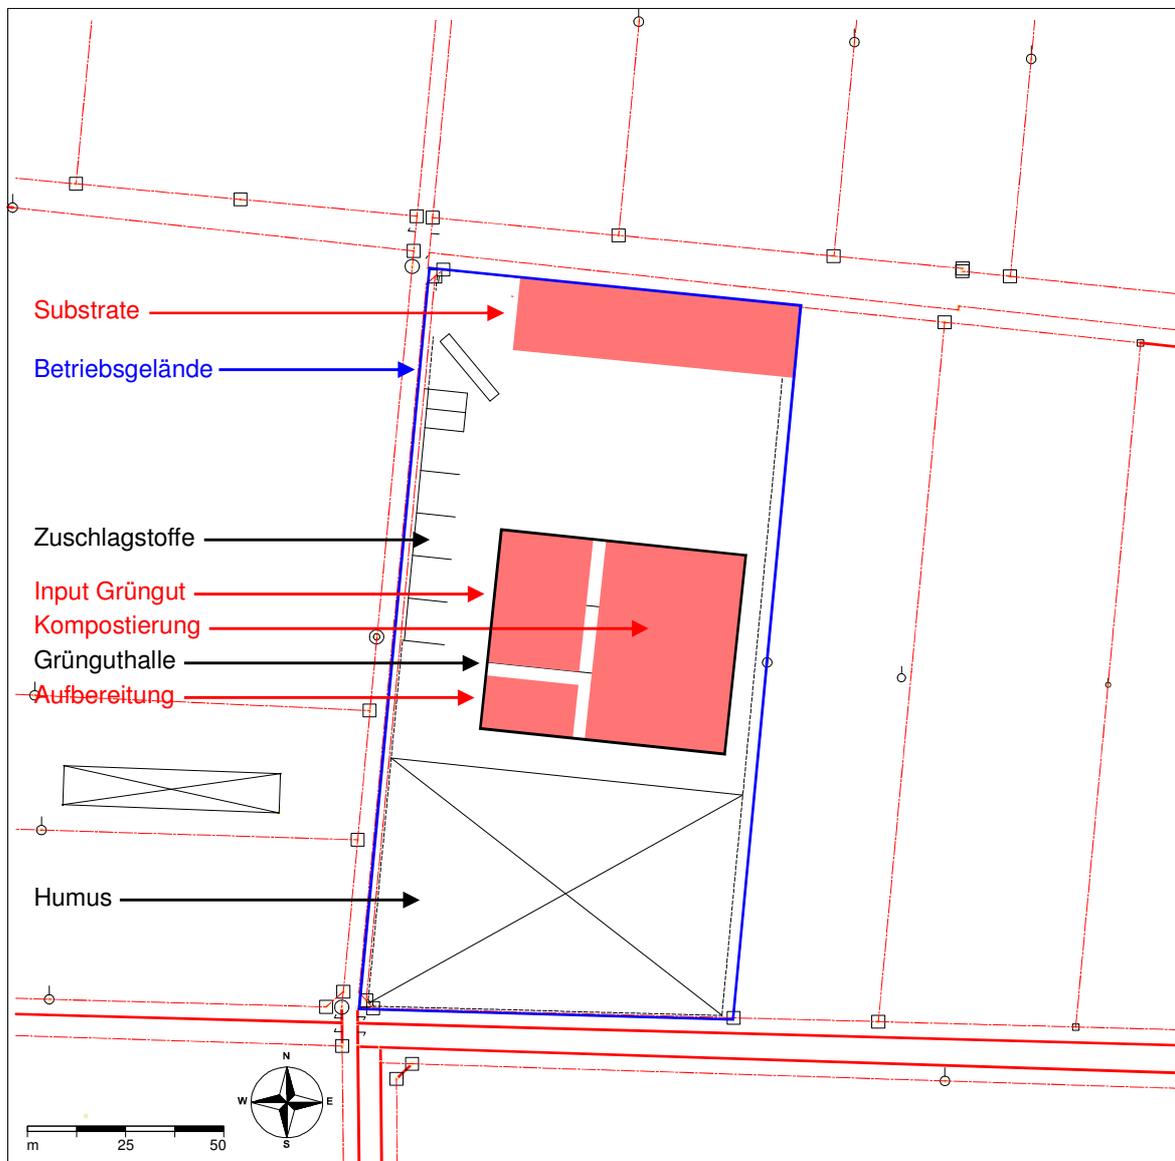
Lageplan mit Lage der Geruchsquellen (rot)
